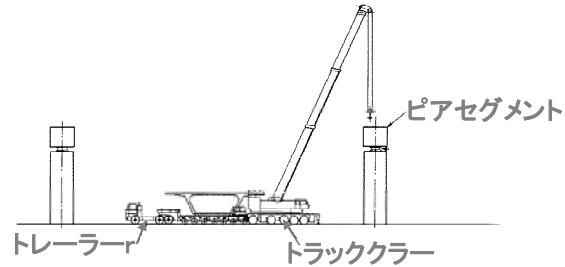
プレキャストセグメント工法による施工イメージ図
